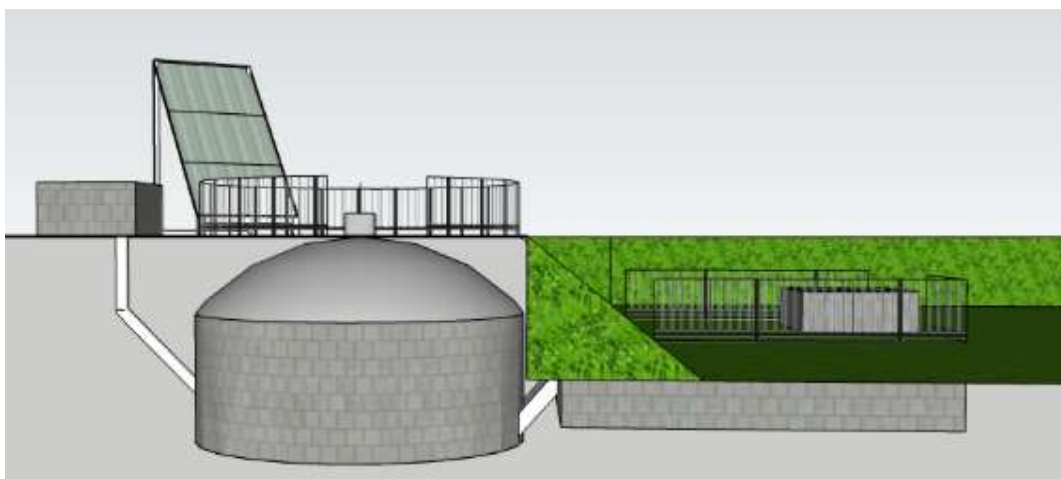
Planta de biogás y posición del conjunto de paneles solares
